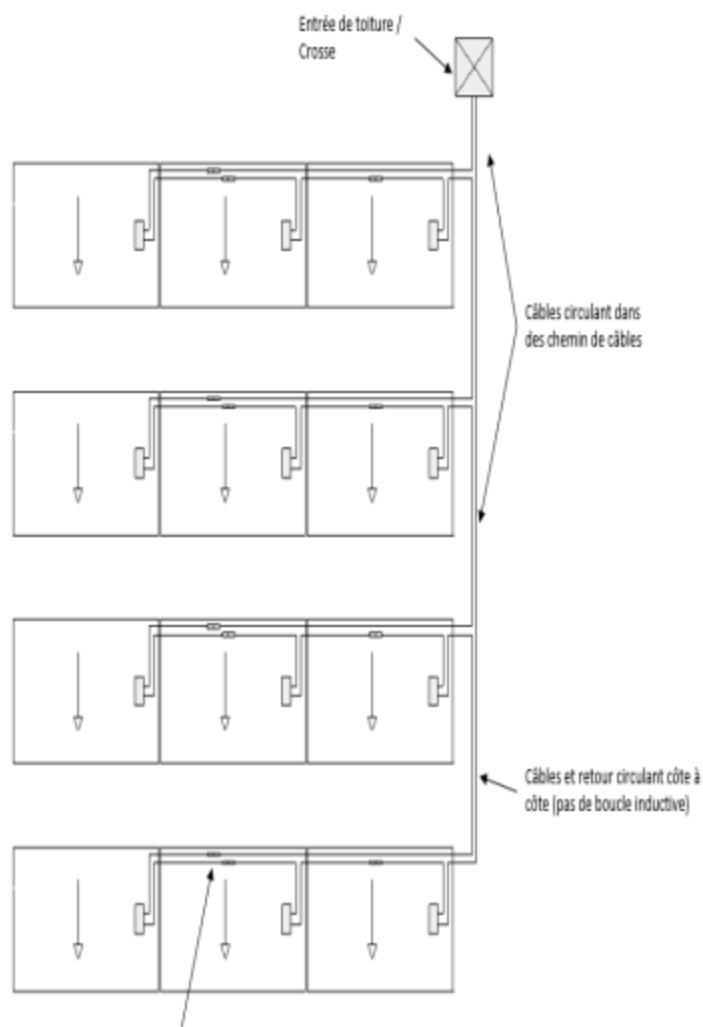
Exemple de plan de câblage des modules photovoltaïques et maintien des câbles
